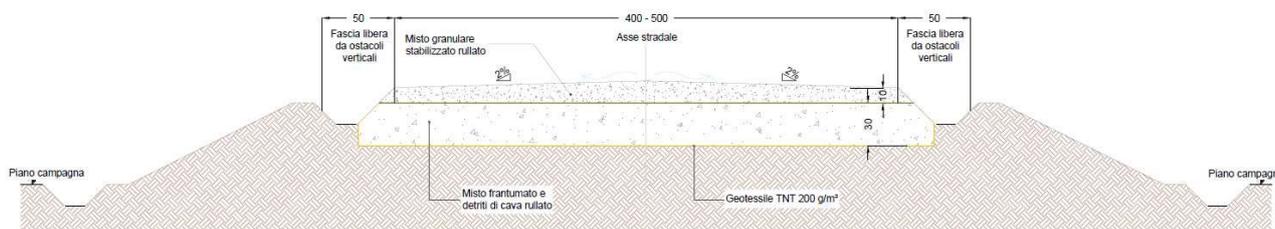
Sezione tipo pista di impianto su rilevato; misure in centimetri.
